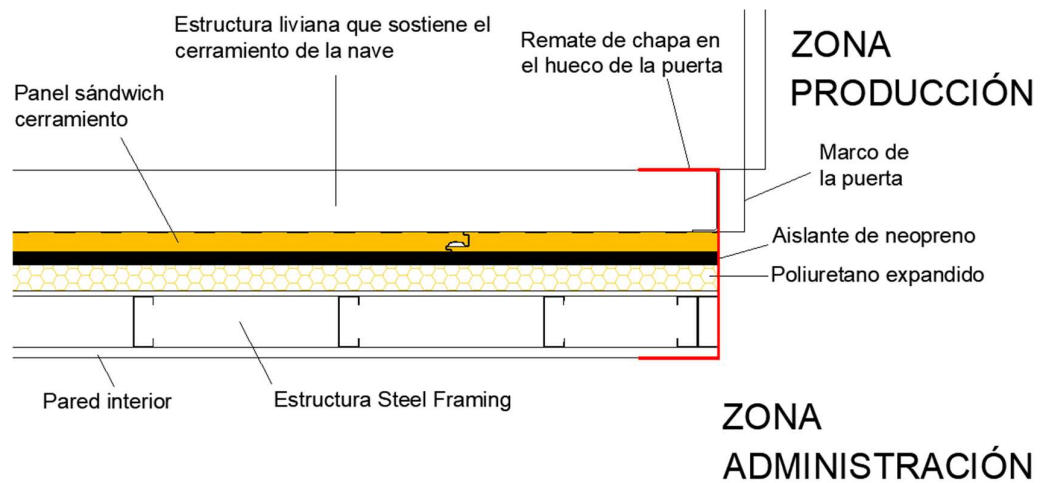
| Detalle unión muro Steel Frame y muro nave industrial en zona de la abertura. Fuente: Elaboración propia.
